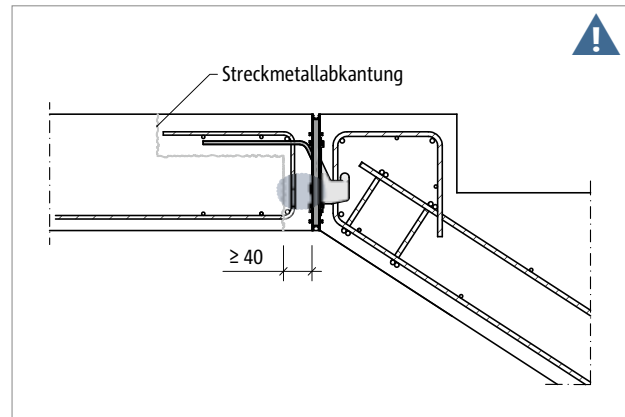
Tronsole® T: Einbau in Verbindung mit Arbeitsfugen am Deckenrand, Druckfuge deckenseitig
